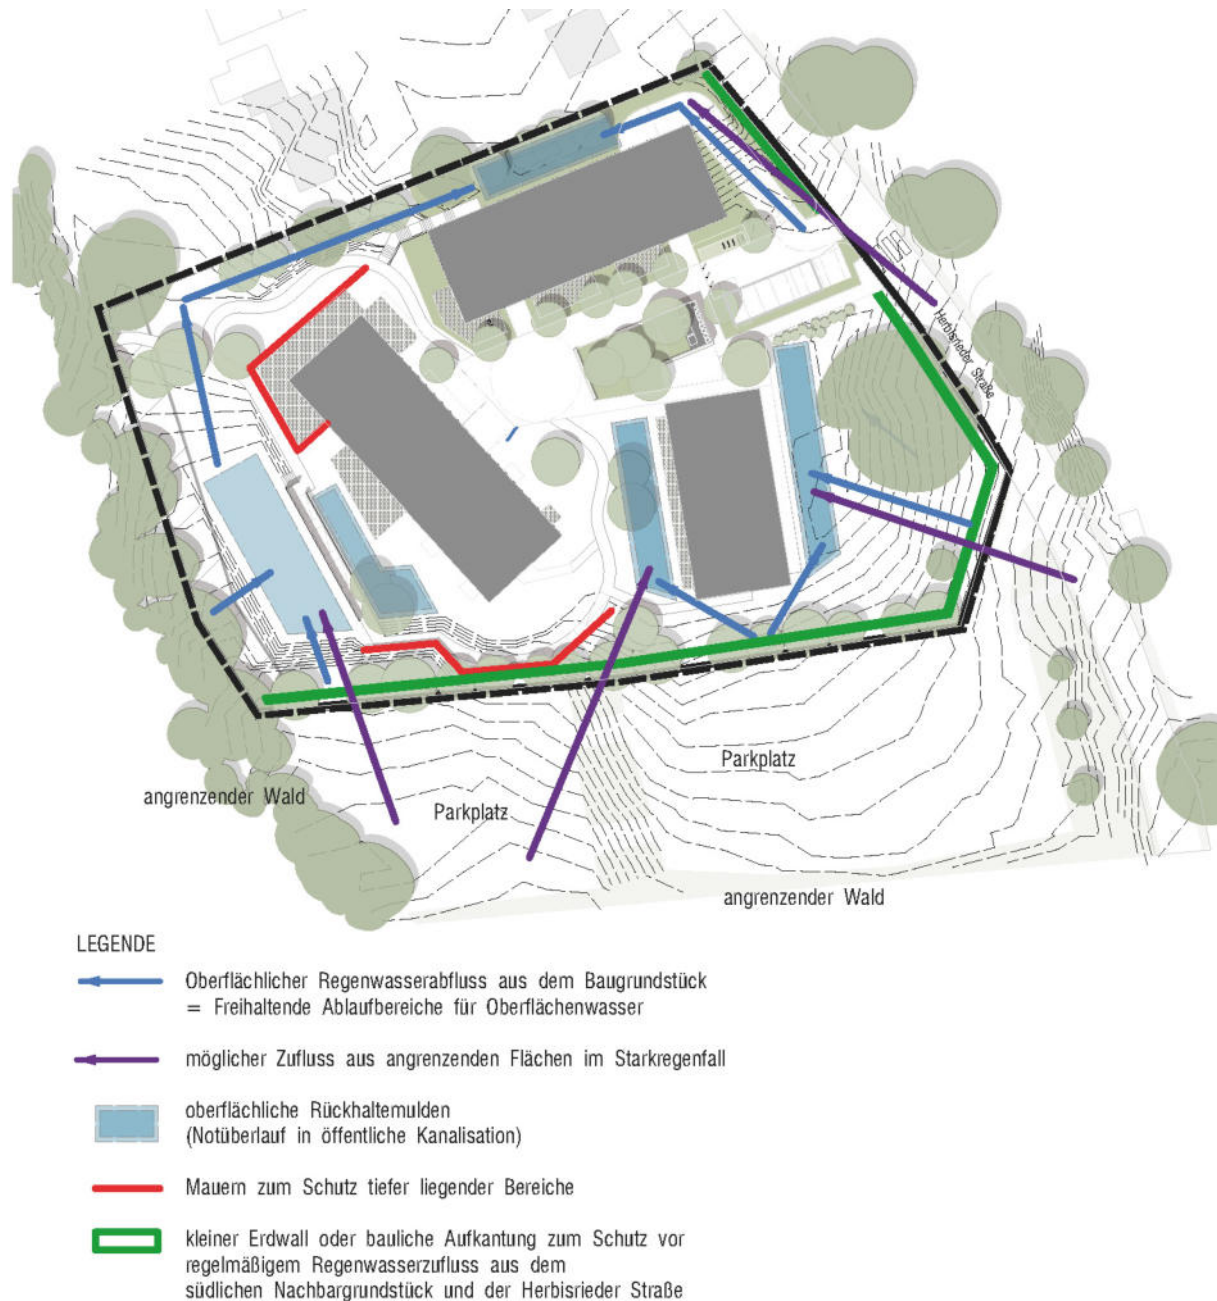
Entwässerungskonzept Baugrundstück, Welsch + Egger Landschaftsarchitekten, maßstabslos
